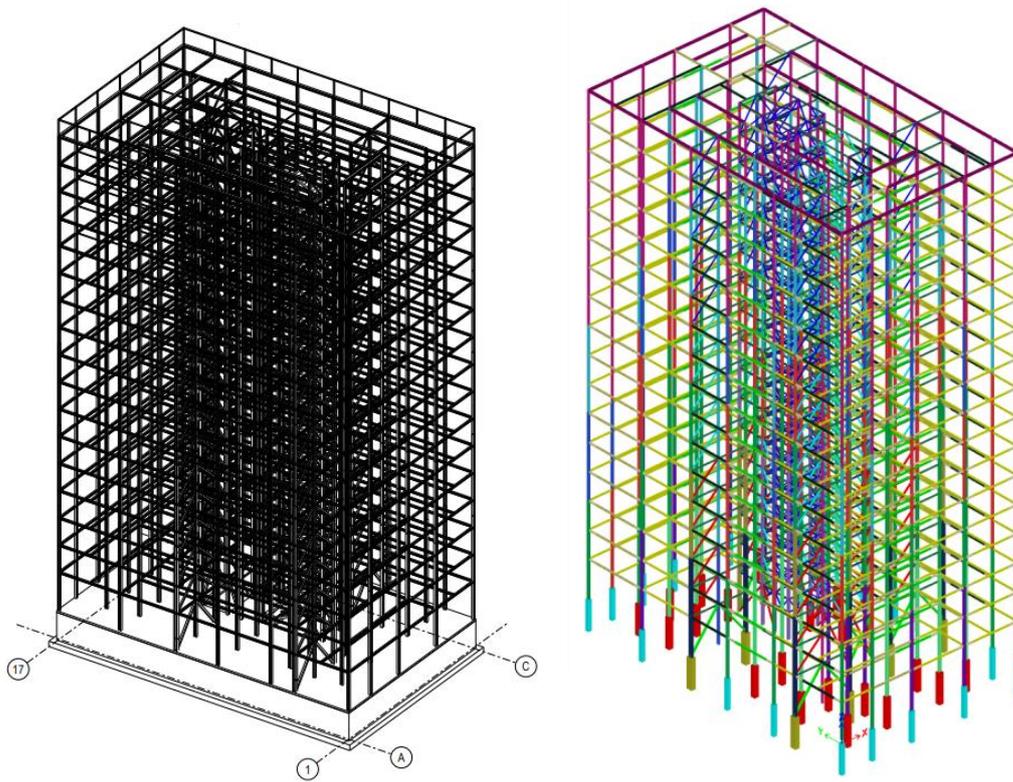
Стальной каркас 17-этажного жилого здания: конструктивная система (слева) и расчетная схема
